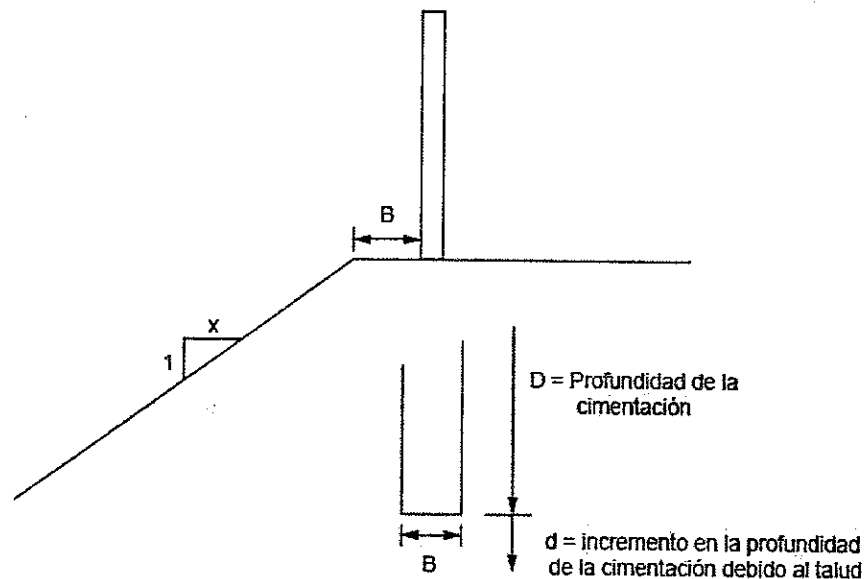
Detalle de la cimentación en un terreno inclinado (WSDOT, 2006)
